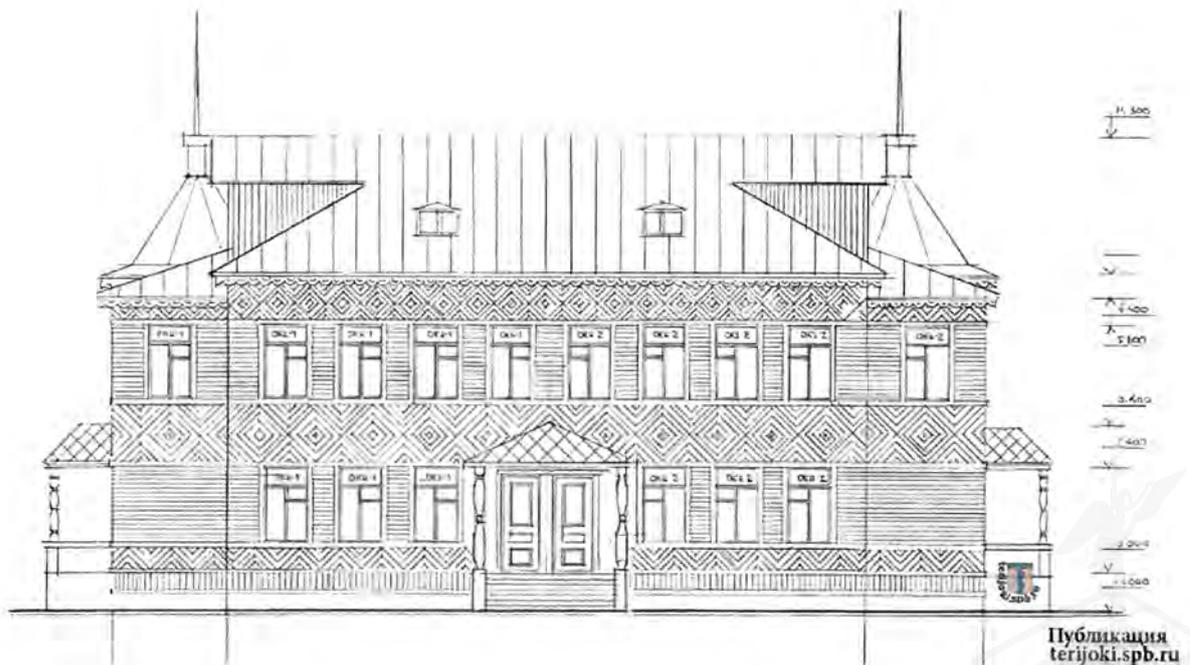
Сестрорецк. Жилой дом по ул. Андреева, 3. Восточный фасад.
